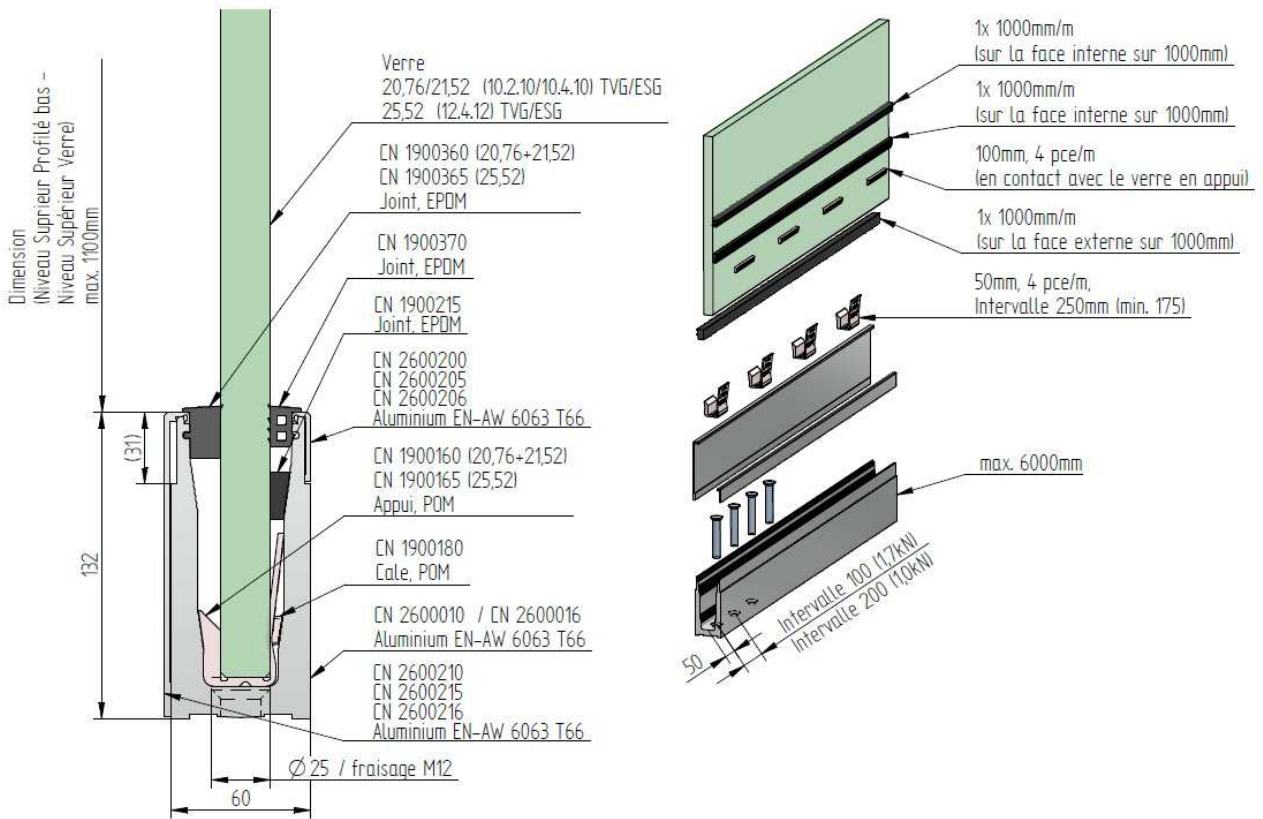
CROSLUX 2.0 – Montage sur dalle
